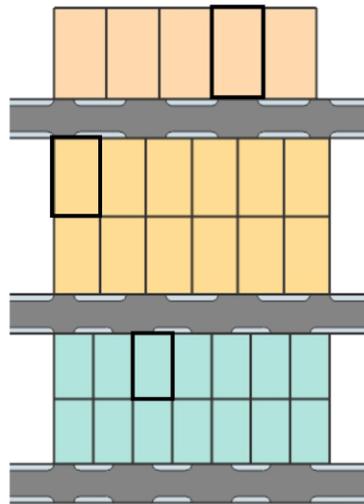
Aplikasi Massa pada Tapak (Alternatif 3)
